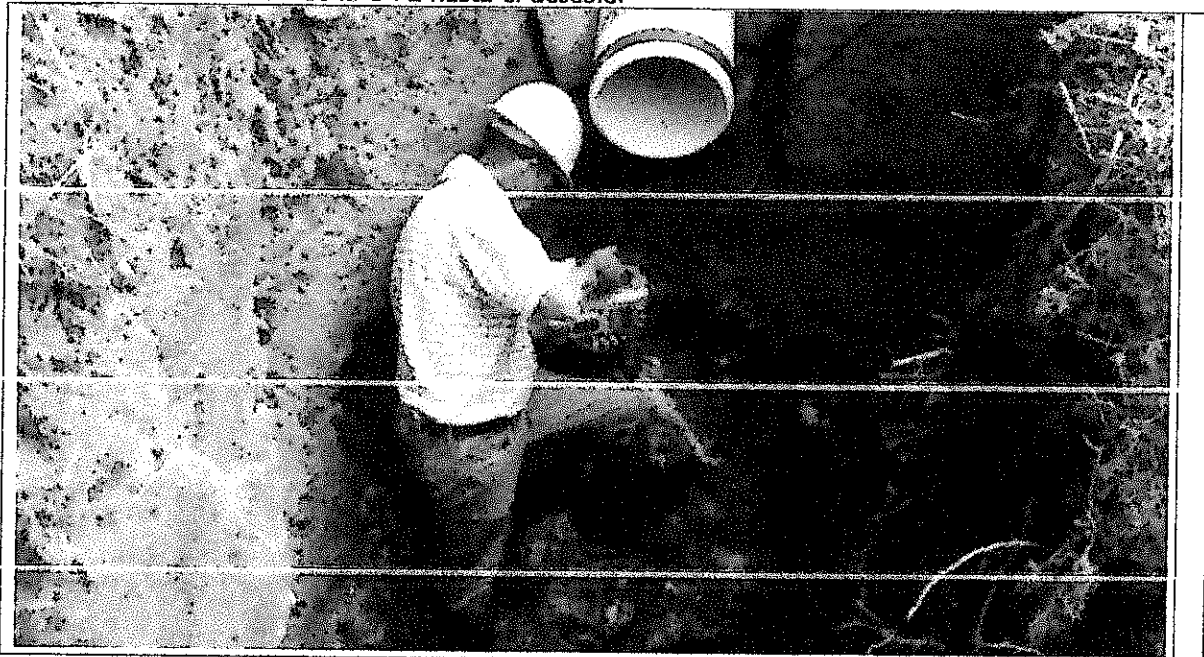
y 10. Construcción de trinchos para soportar y mejorar las condiciones del terreno y la zona por donde se instaló la tubería
